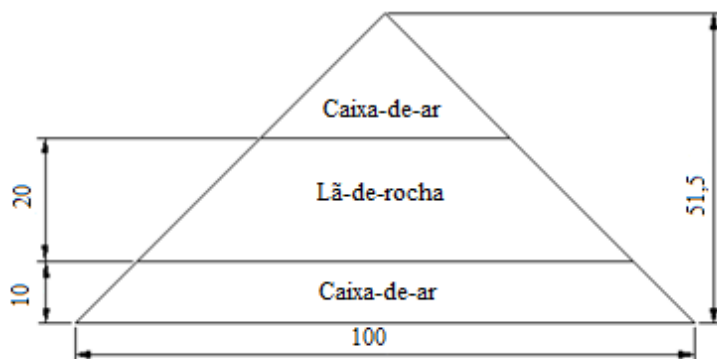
Dimensões [cm] em planta: painel liso com lã-de-rocha de 200 mm (L200)
